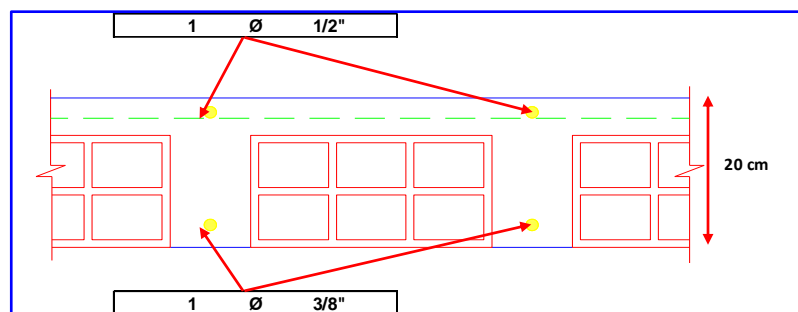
Detalle del Acero en Vigueta del Módulo A3
